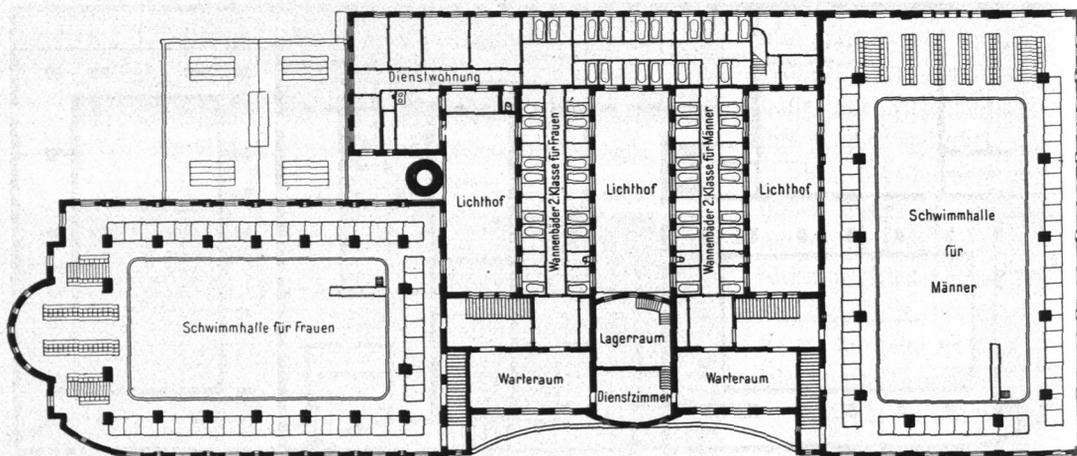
Badeanstalt Hammerbrook, Obergesch. Grundriß.
